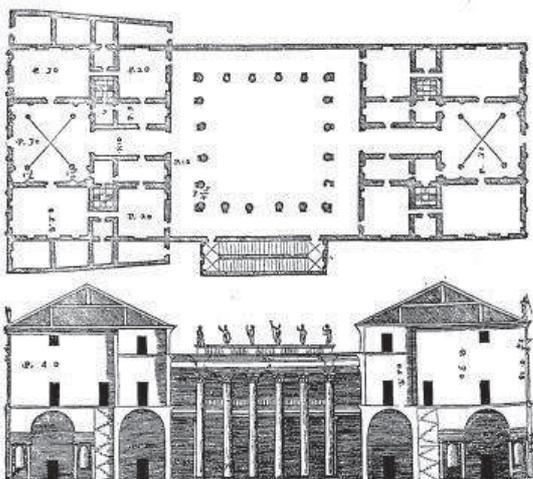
Planta baixa e fachada do Palácio Iseppo Porto. Fonte: <http://hermes.ucs.br/ccet/deme/emsoares/inipes/palladio/>
